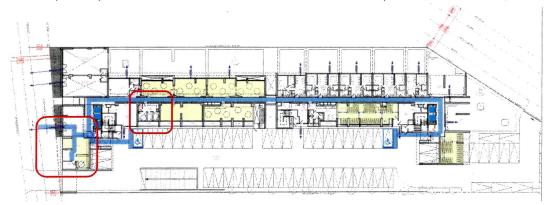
planta piso 1 con ruta de accesibilidad universal
